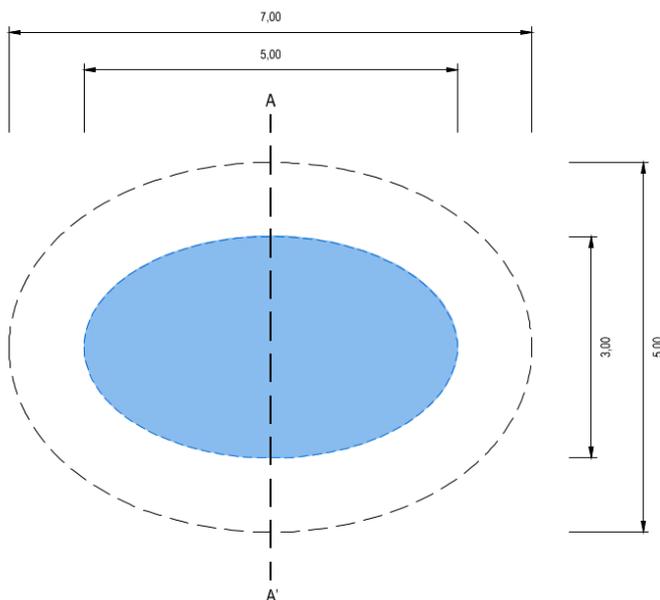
Beispielhafter Grundriss eines Kleingewässers (blau: vorgesehen wasserführender Flächenteil; gestrichelt: Umgriff der Abgrabung)
